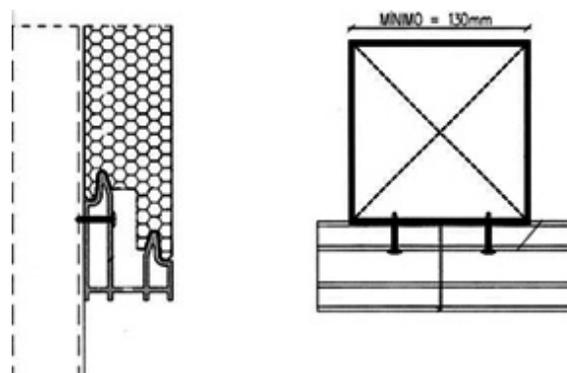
Detalhe de fixação e emendas de apoio suspensos. (DÂNICA, 2013a)
